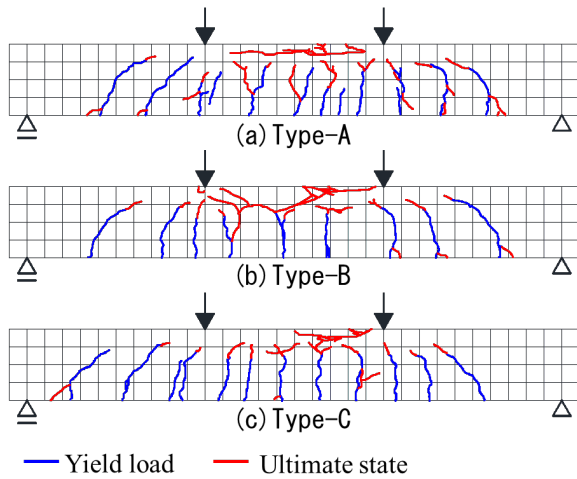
試験体のひび割れ進展図 (単位 : mm)
